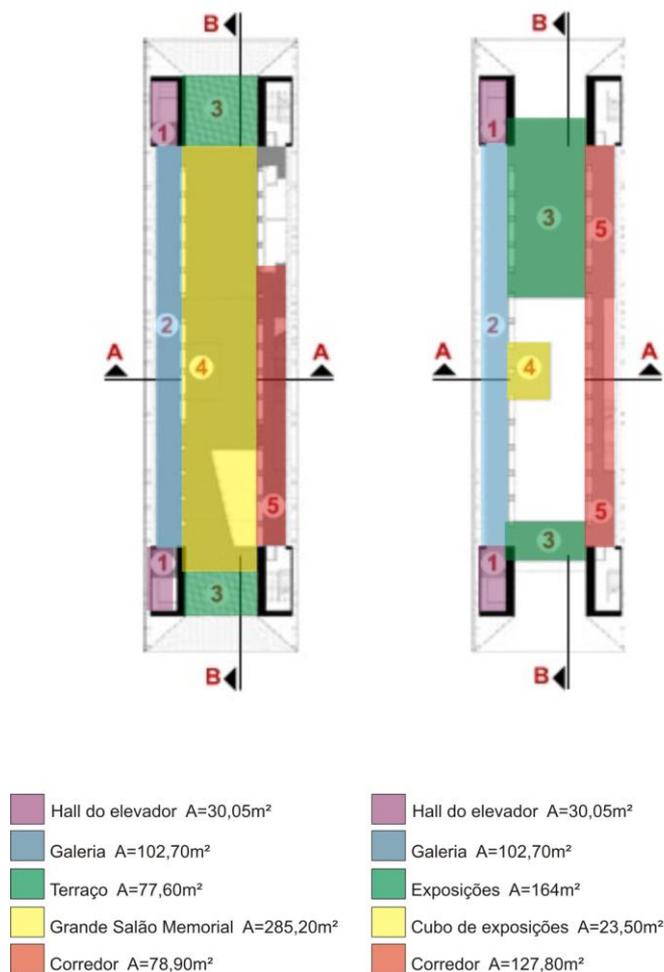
Planta Baixa Nível 1,70/ Planta Baixa Nível 6,46 (ARCOWEB, 2010)
